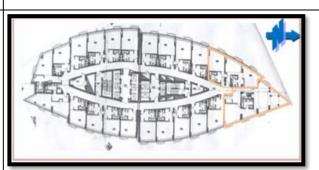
Le plan du 8^{éme} au 12^{ème} étage
